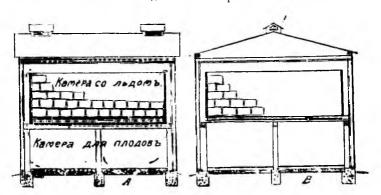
Продольный и поперечный разръзы постройки для храненія льда въ верхнемъ этажъ и плодовъ въ нижнемъ.
